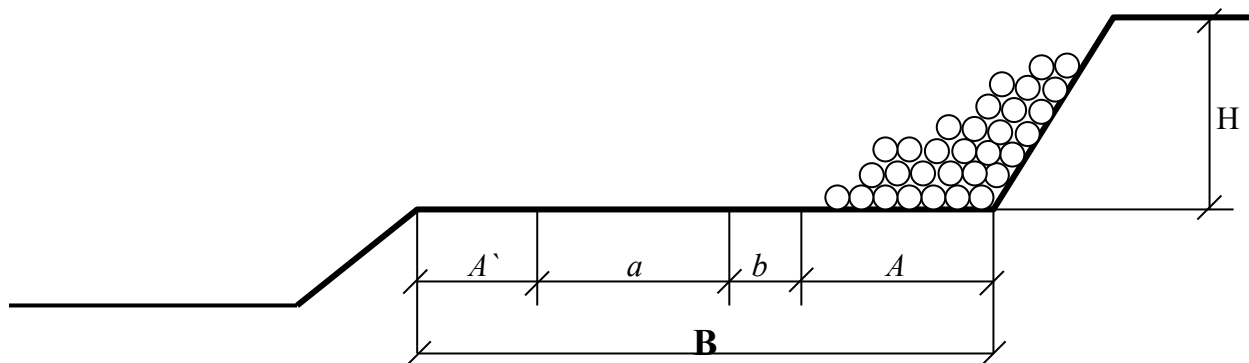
Расчетная схема для определения ширины рабочей площадки
